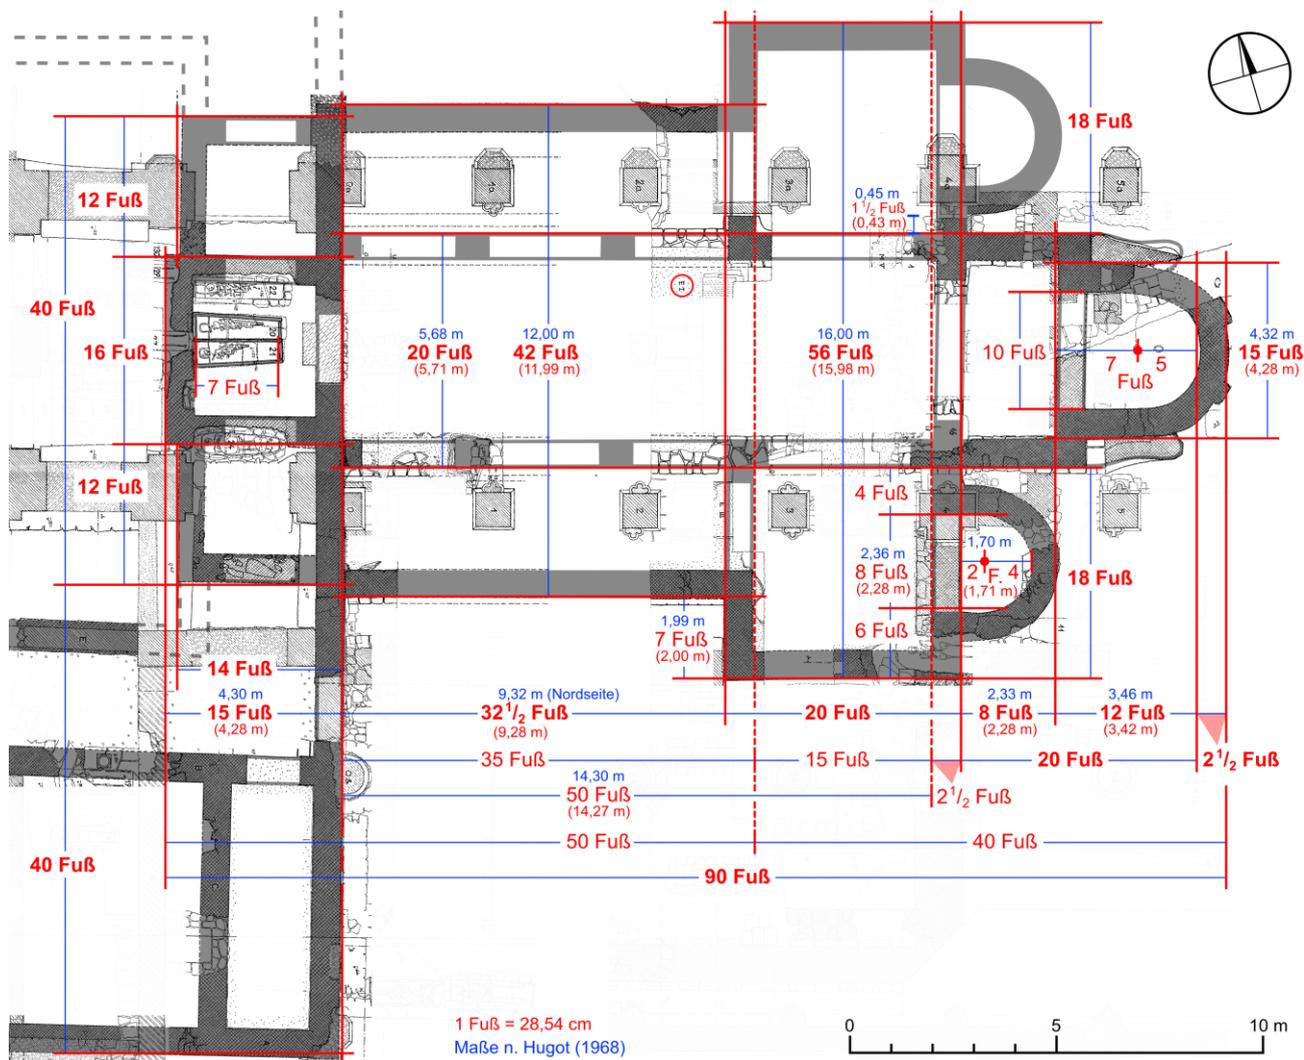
Der Grundriss der Abteikirche von Inda
